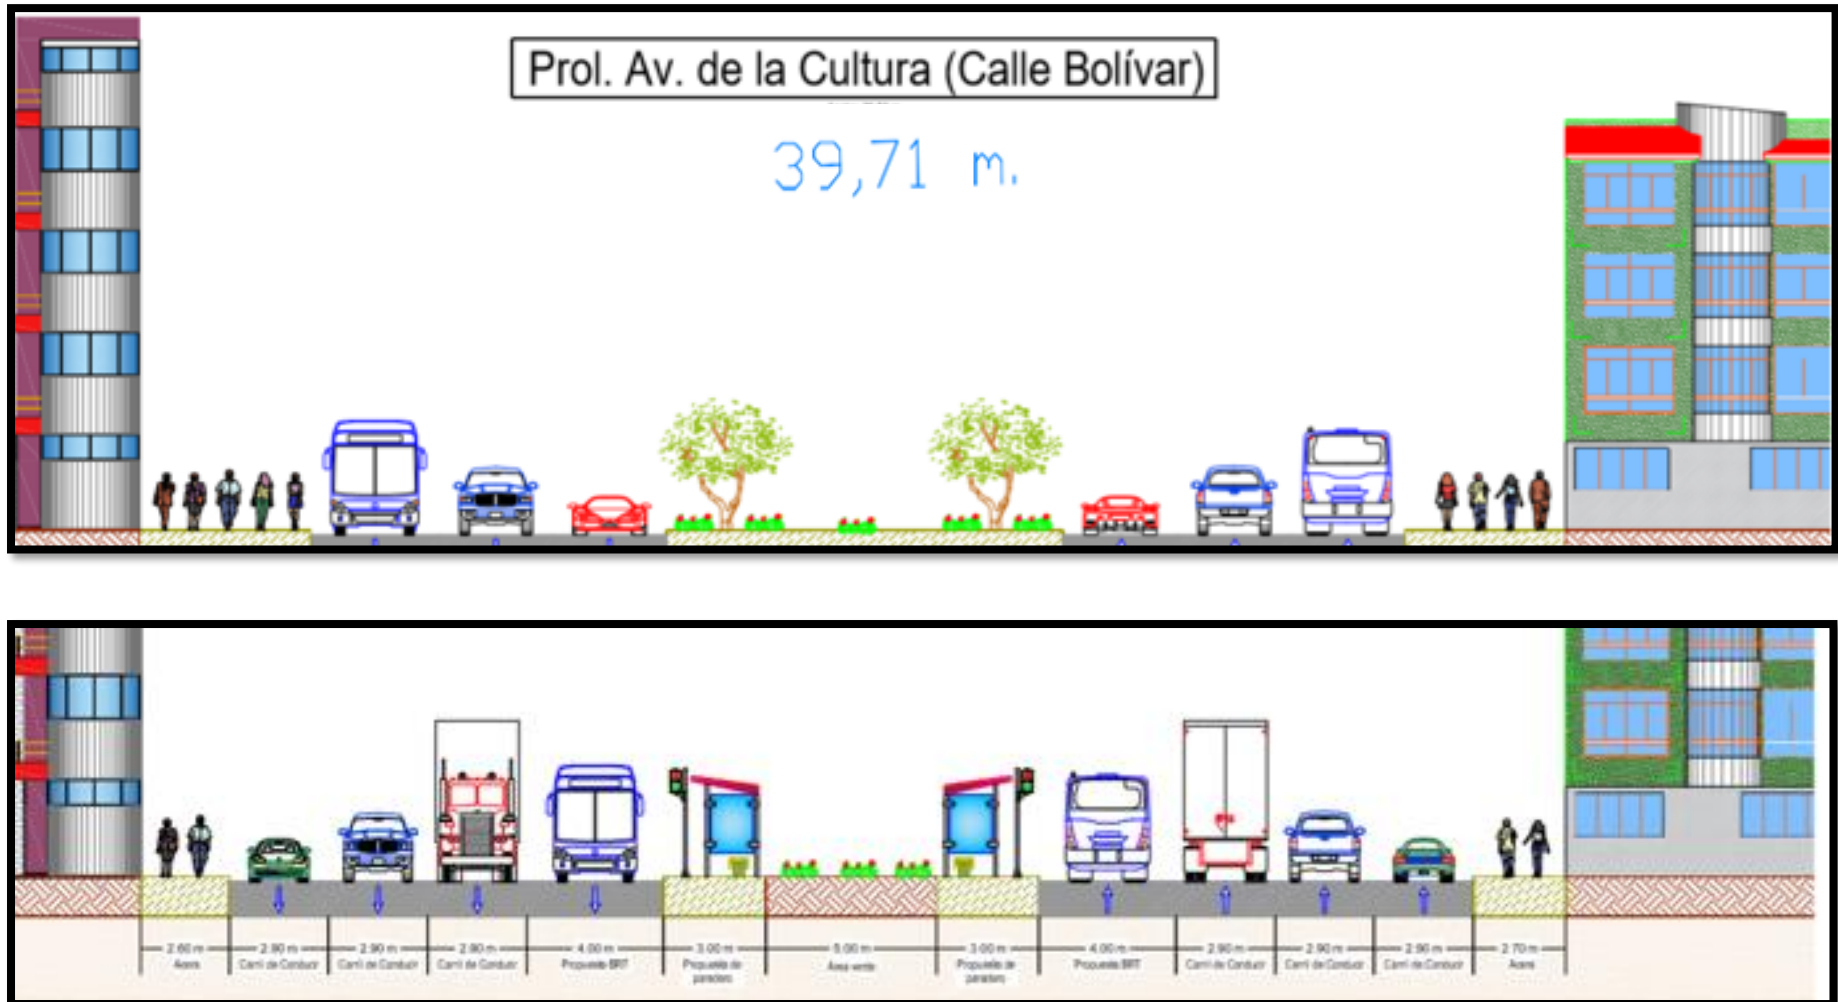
Comparación de las secciones transversales en (Calle Bolívar)
